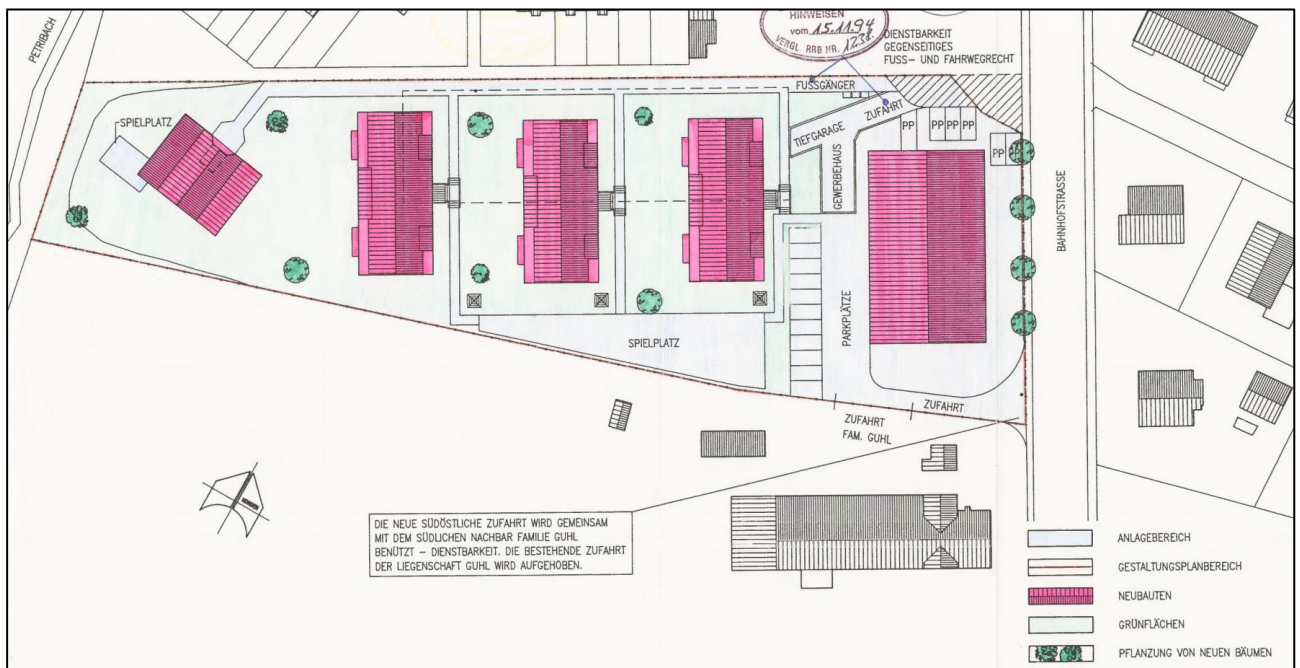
Gestaltungsplan Mühlebach: Plan 2 (Situation mit Umgebung).
